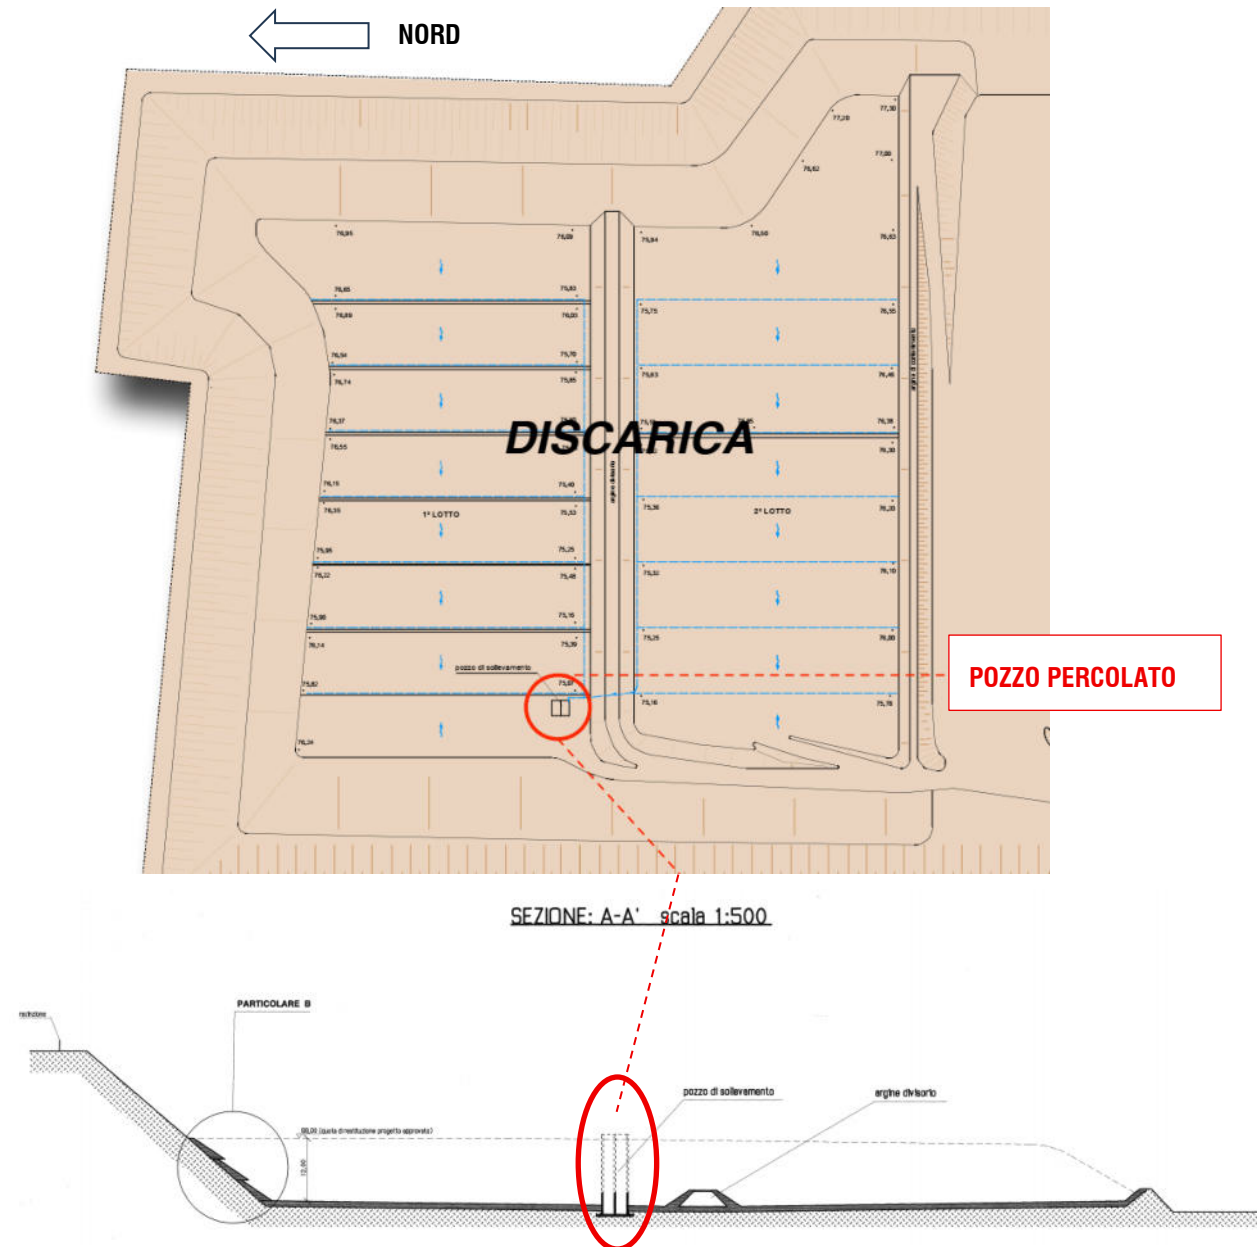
Pianta e sezione del fondo bacino di progetto con posizione del pozzo del percolato
